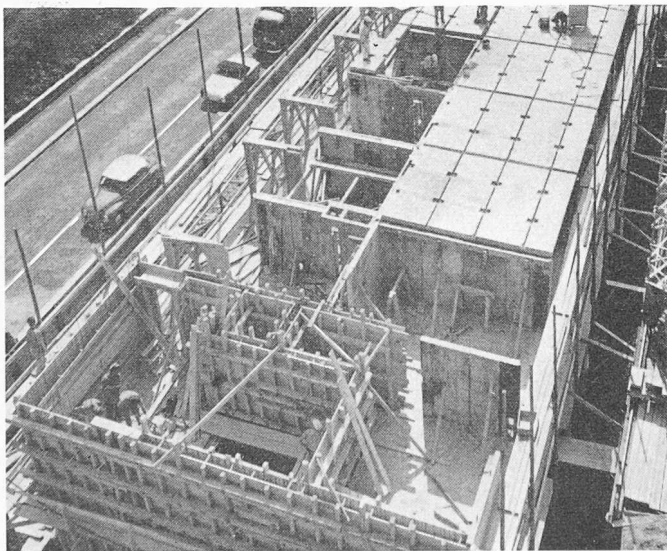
Verlegen der Elemente einer Geschossdecke des Hochhauses. Im Vordergrund die verschalteten Wände des Treppenhauses, das in Ortbeton erstellt wird.
